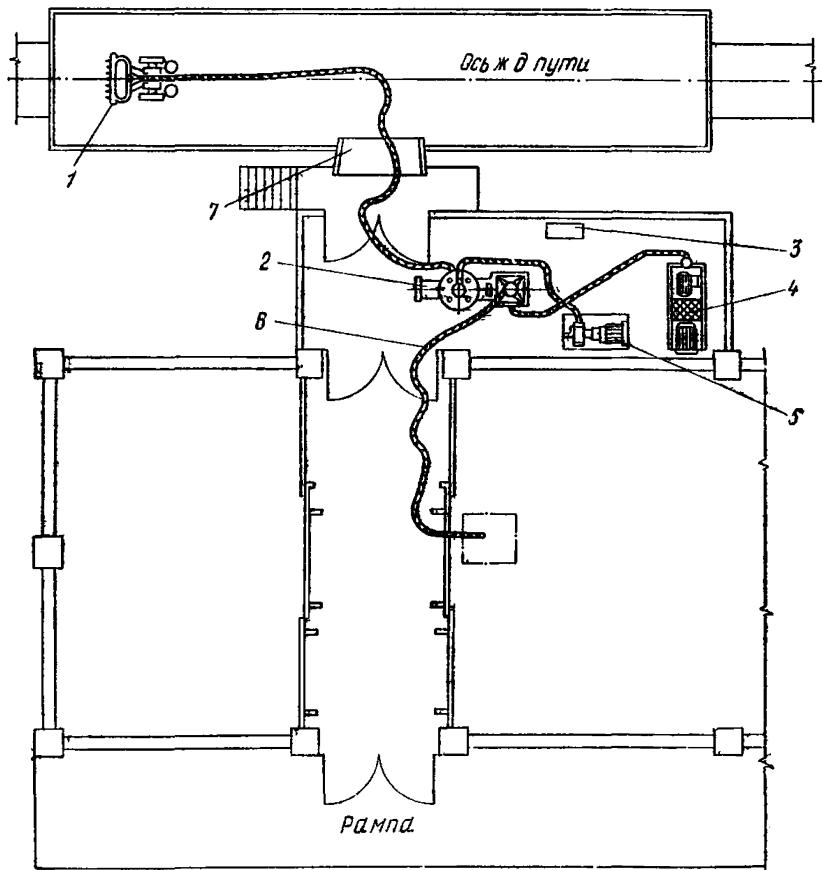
Схема выгрузки цемента из крытого вагона в склад
